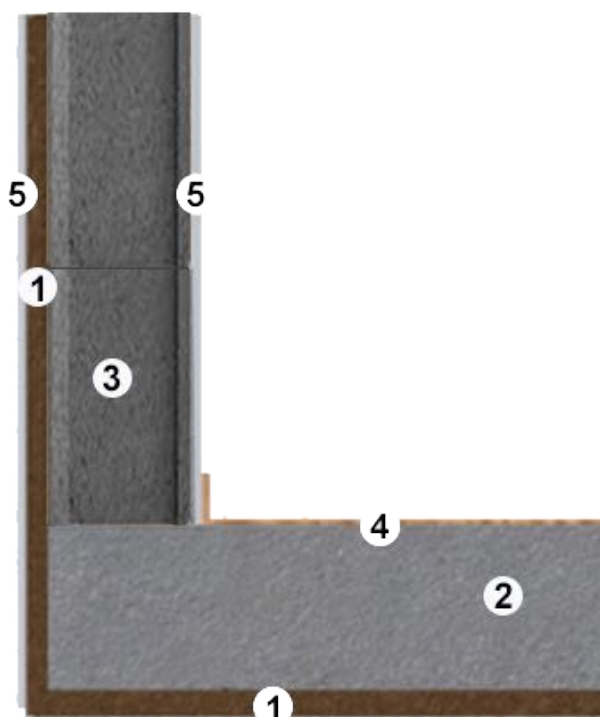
● Isolamento pelo exterior - Sistema ETICS (na parede)
